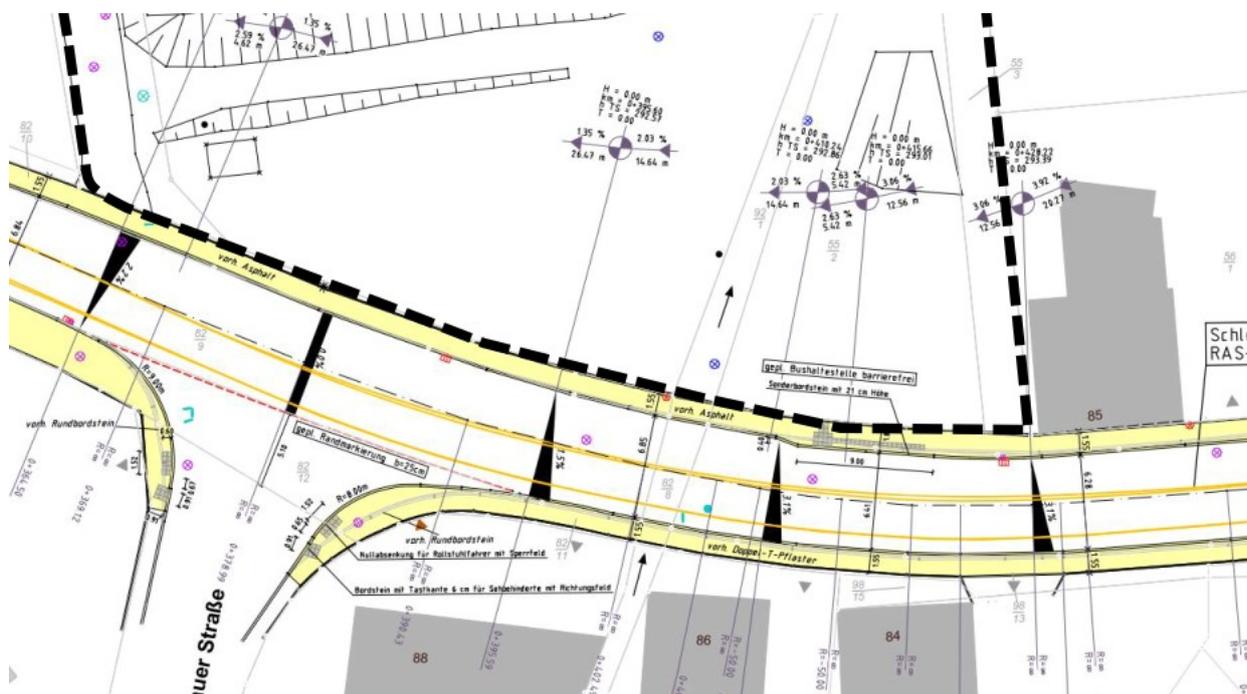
Geplanter Ausbau Langgasse 7(Plangebiet = Schwarz umrandet)
